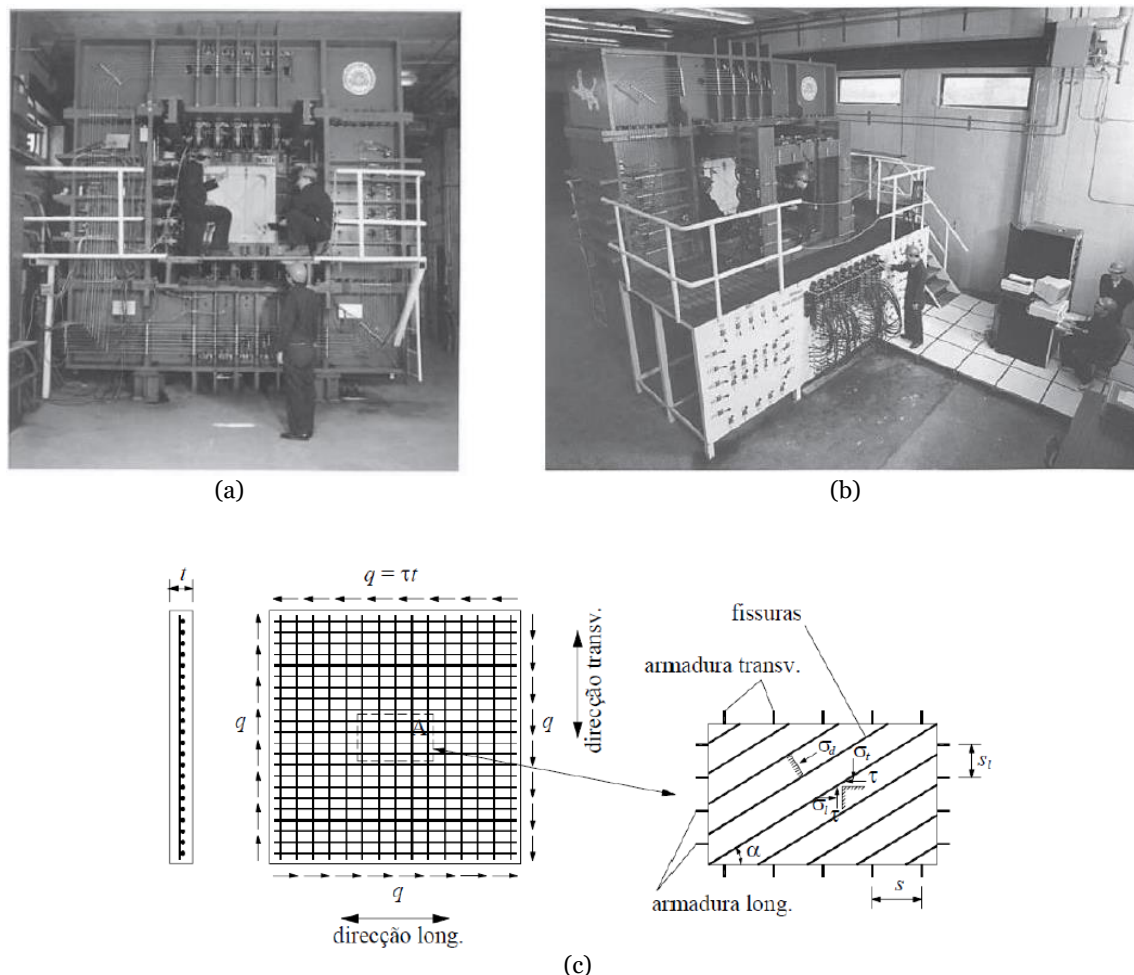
Ensaio de painéis de betão armado no *Universal Panel Tester* [58]: (a) vista norte, (b) vista sul. (c) Exemplo geral de uma placa sujeita ao corte [13].
